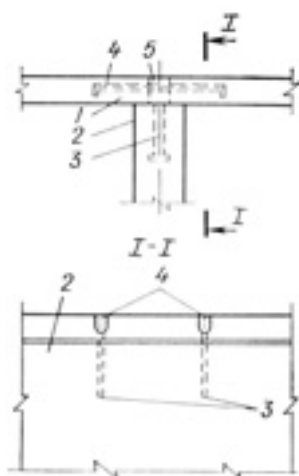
Установка анкеров между перекрытиями и внутренними стенами: 1 – сборные элементы перекрытия; 2 – внутренние стены из каменных материалов; 3 – анкеры, выпускаемые из кладки в швы между элементами перекрытия; 4 – арматурные стержни, укладываемые в швы между сборными элементами; 5 – монолитный бетон
